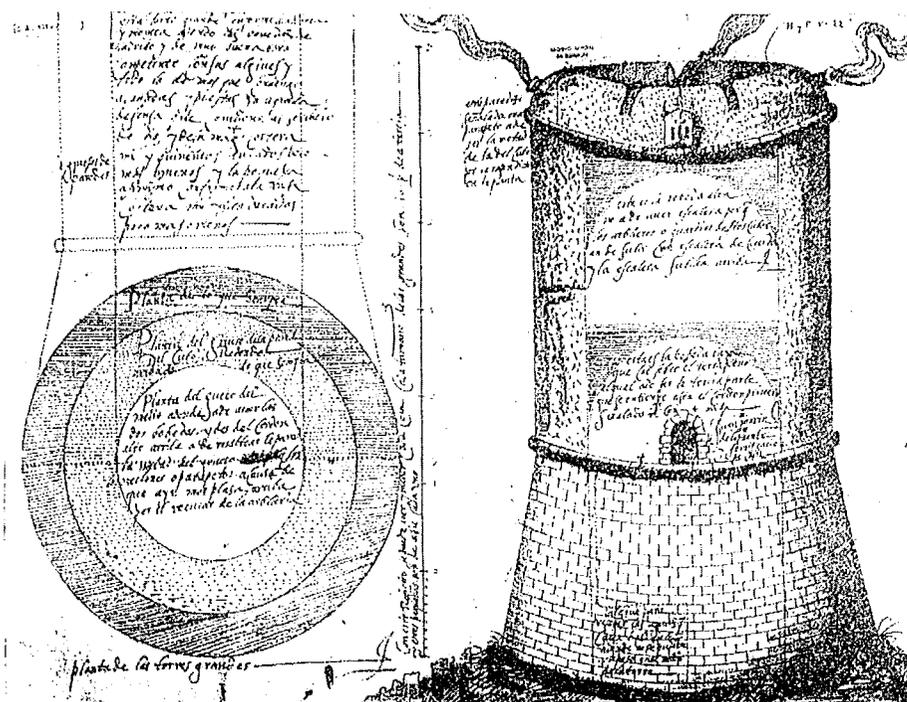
Vigía hispana, siglo XVI. Planta y corte transversal de una torre vigía con doble bóveda, por Juan María de la Puente.
